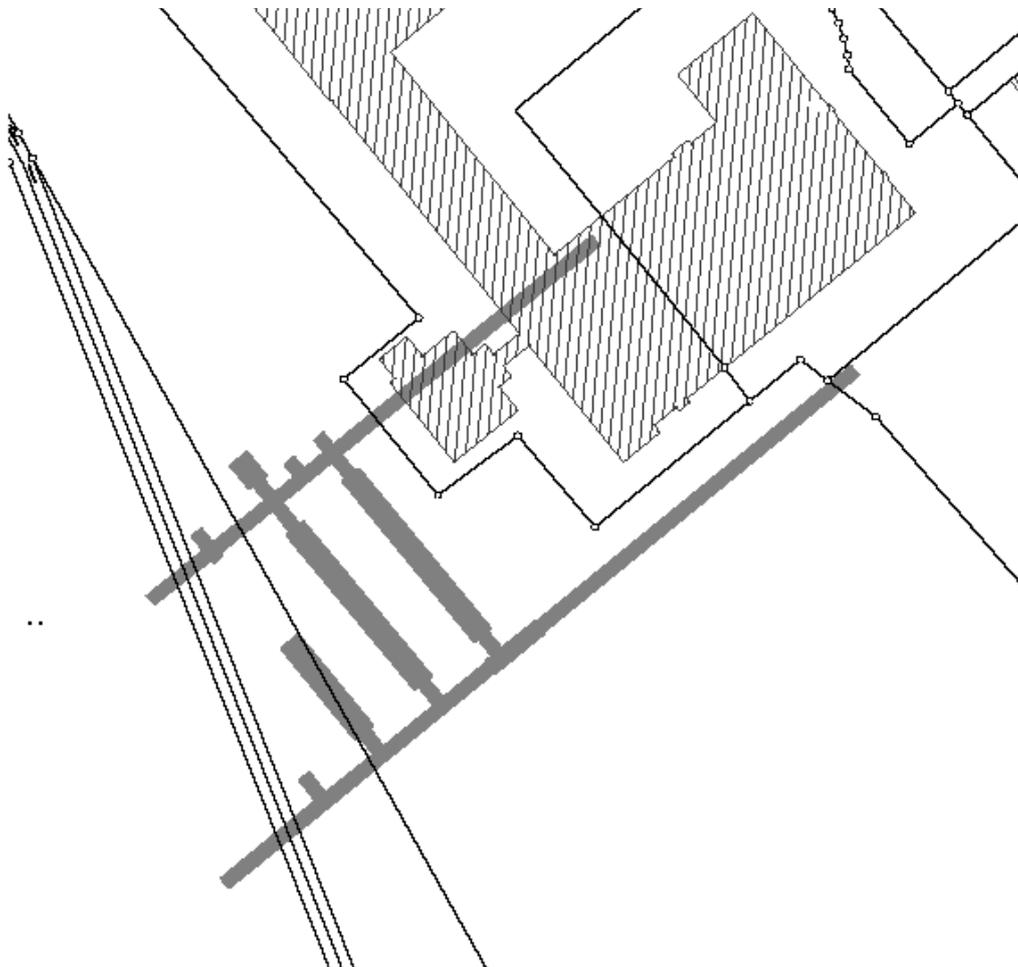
Lageplan Luftschutzstollen FACHHOCHSCHULE
